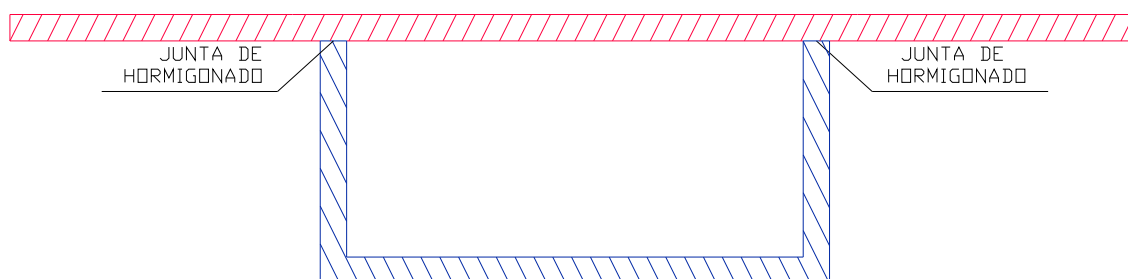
5. Junta de hormigonado en sección cajón construida sobre cimbra total (1º fase en azul y 2º fase en rojo).
